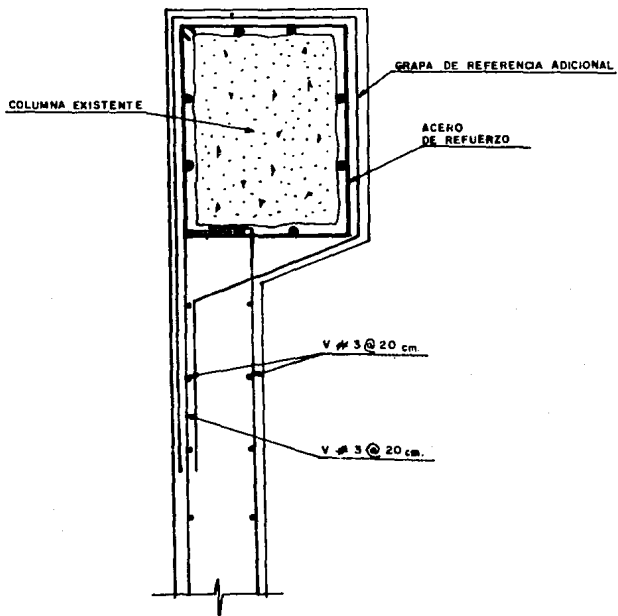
ANCLAJE DE MURO EN ENCAMISADO DE COLUMNAS
